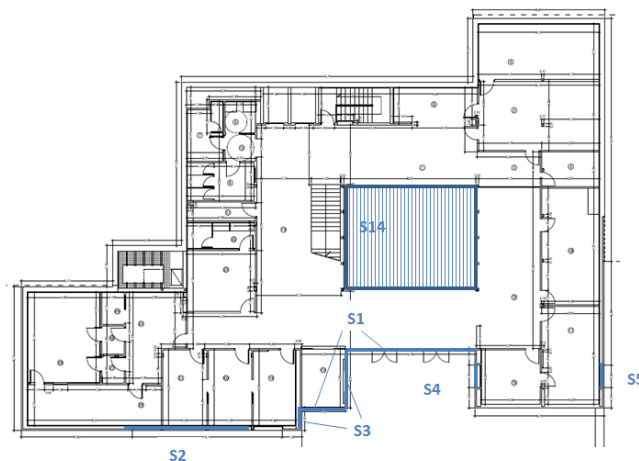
ventanas definidas en la planta baja y número de sombreado correspondiente a cada una.
